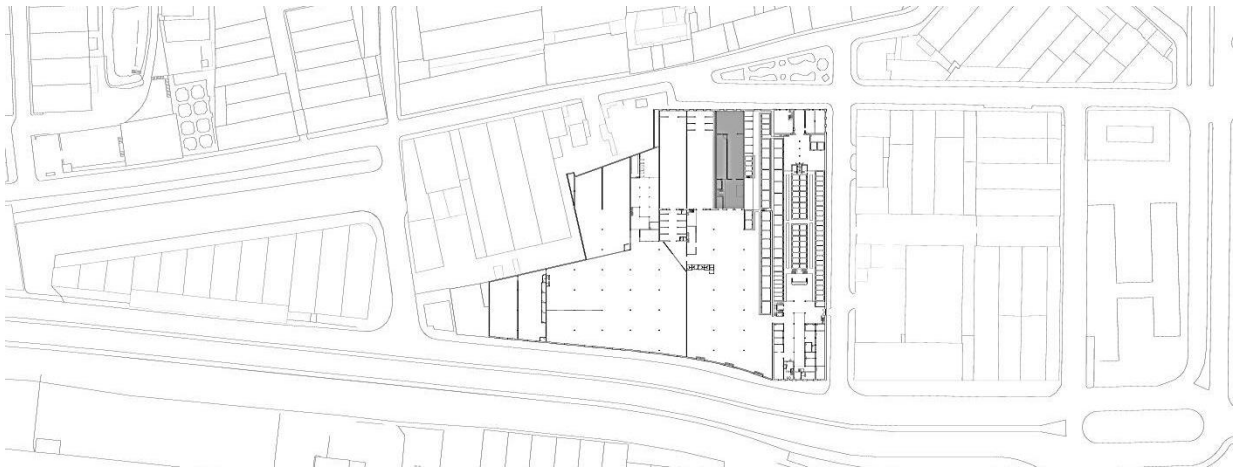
Planta de levantamento fotográfico piso térreo – Armazém 6.
